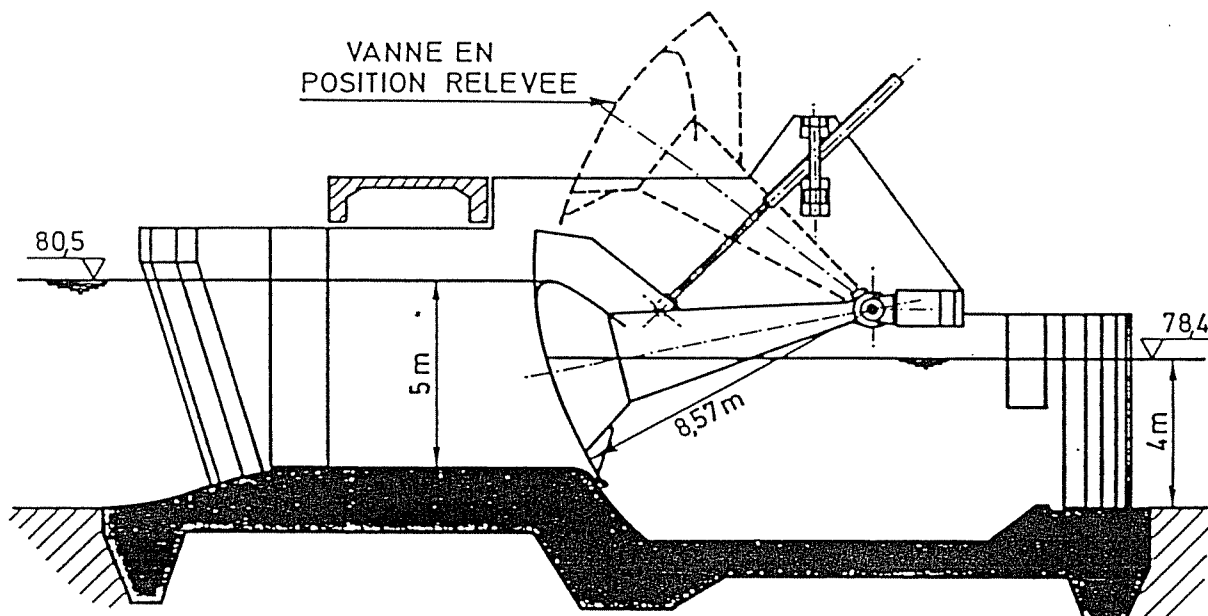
Vue de la vanne segment à corps unique, levante et baissante
